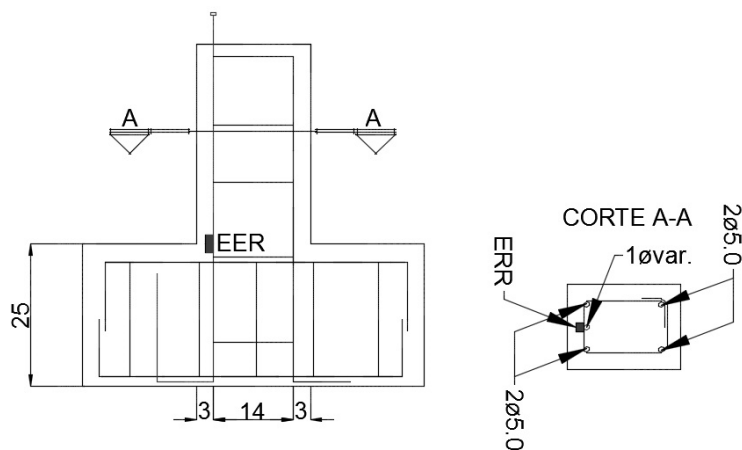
Localização do extensômetro nas vigas (dimensões em cm).
